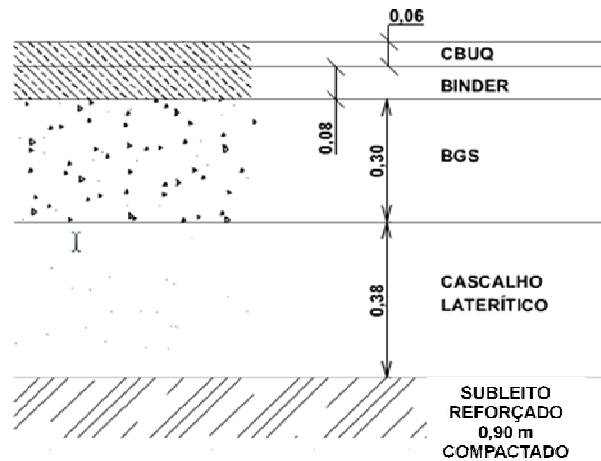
Estrutura do pavimento da segunda pista do AIB, dimensões em metros
